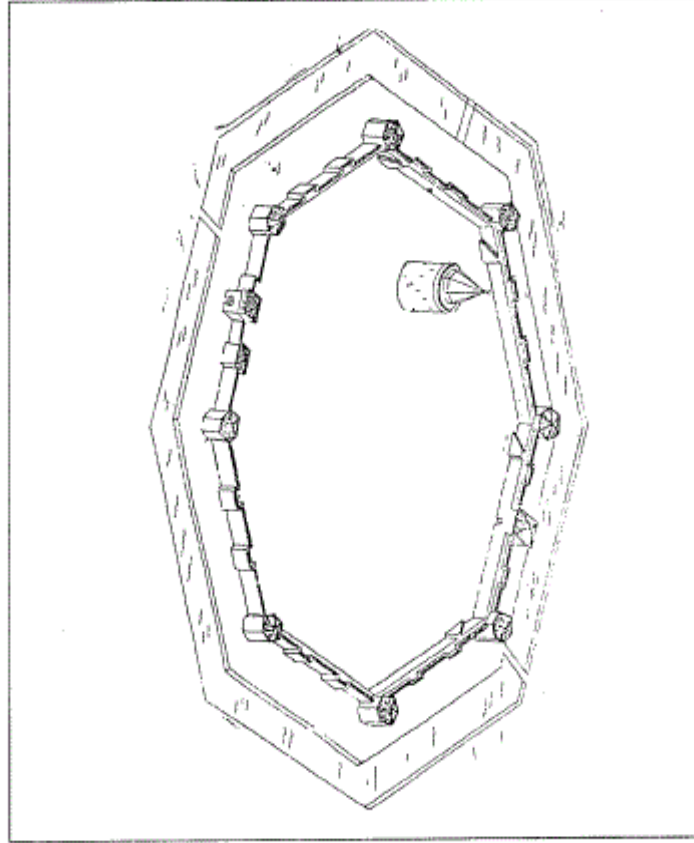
مسقط أفقي لقلعة بركين بألبانيا (عن : كيل).
